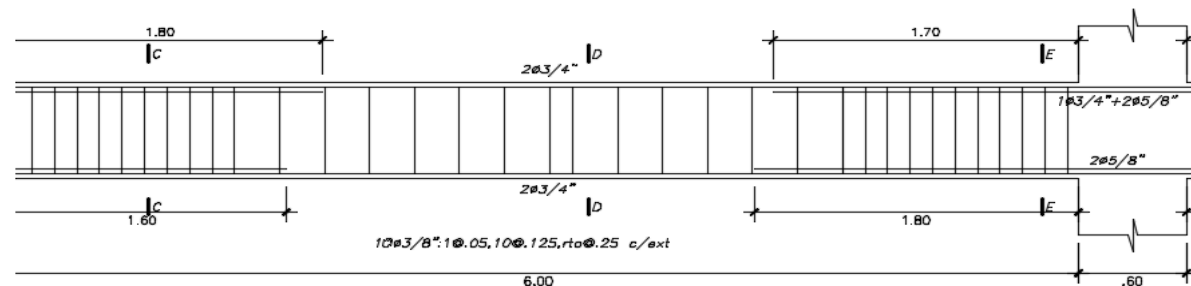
Diseño final viga V-102 (segundo tramo)
